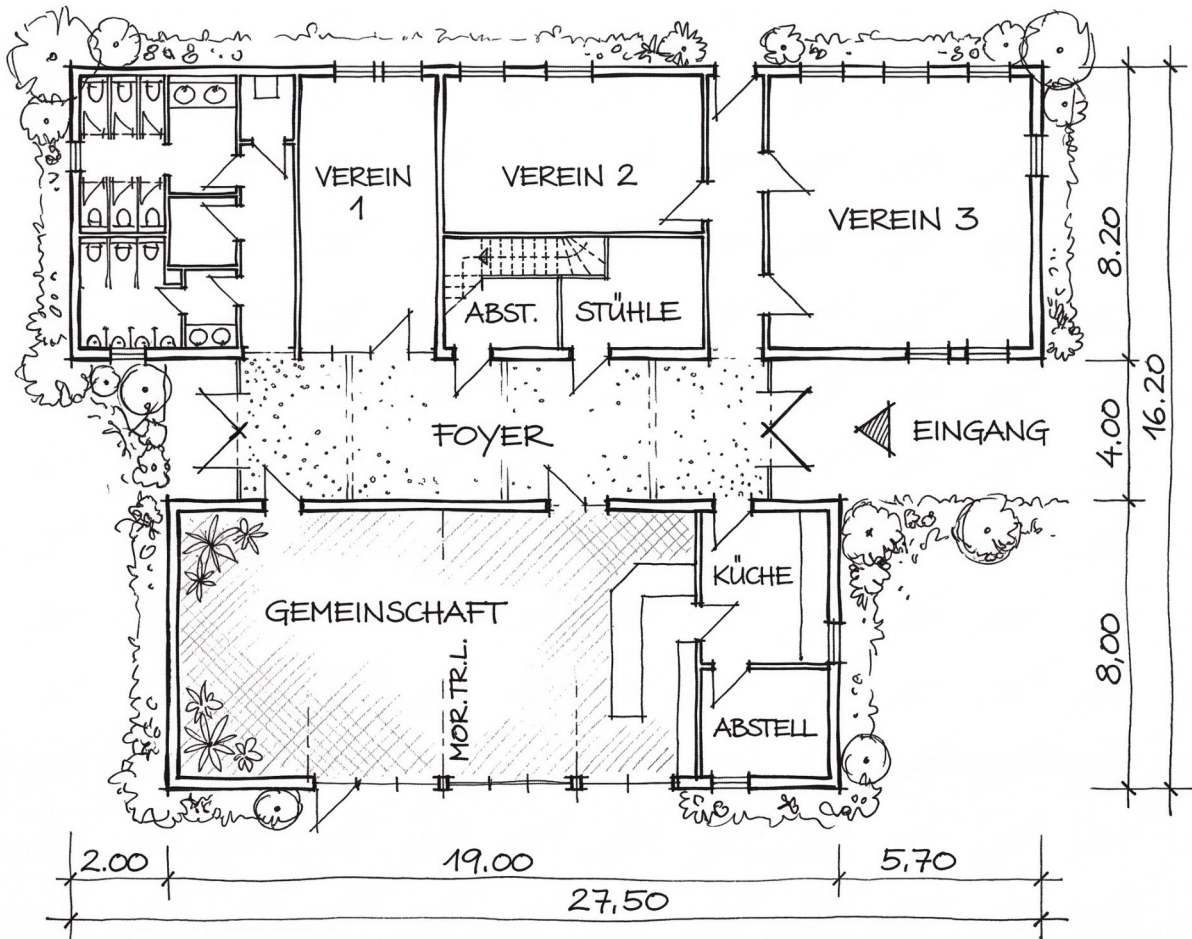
Grundriss Dorfgemeinschaftshaus ;
